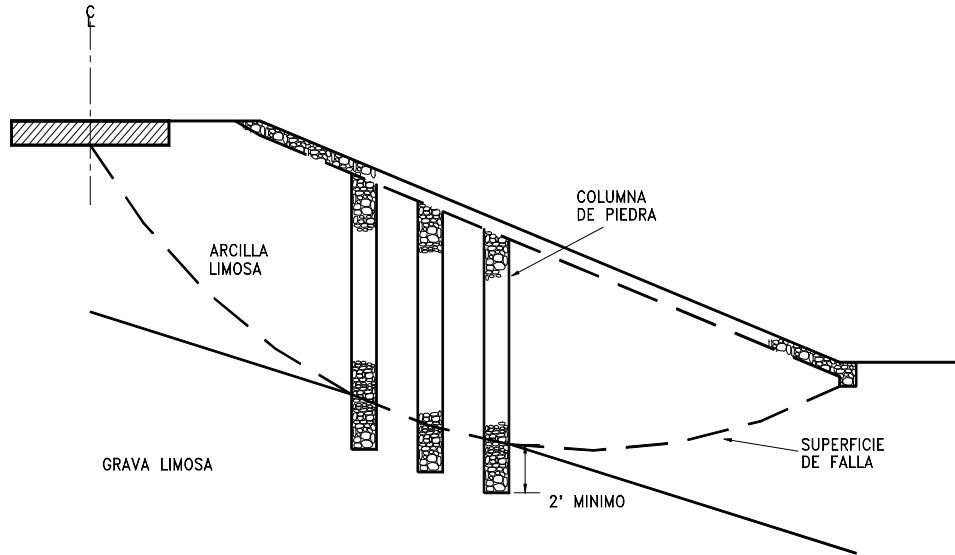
Diagrama esquemático de la utilización de columnas de piedra para estabilizar un deslizamiento.
